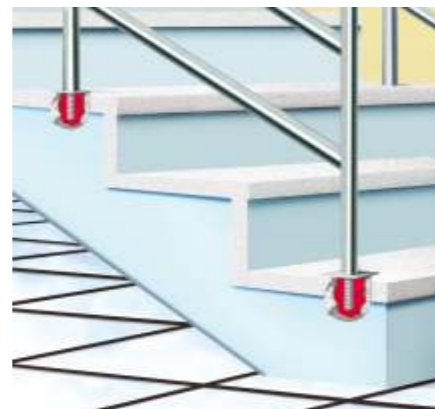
Aplicaciones típicas de anclajes no estructurales
